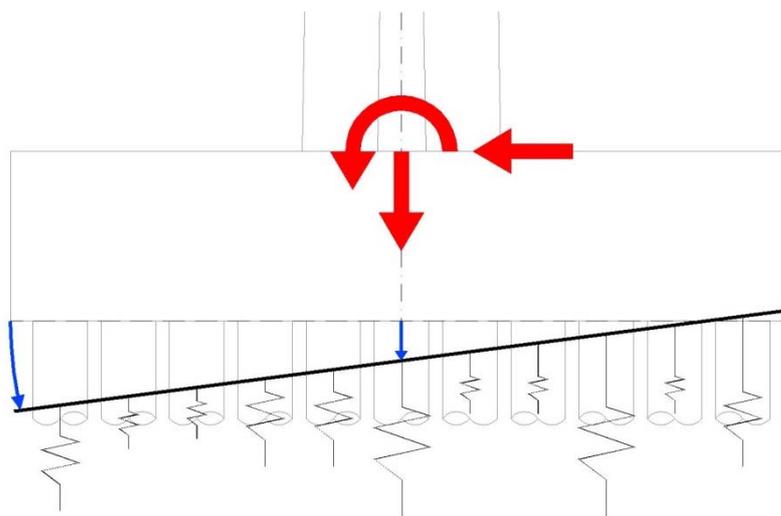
Schema generale di ripartizione rigida su elementi elastici
